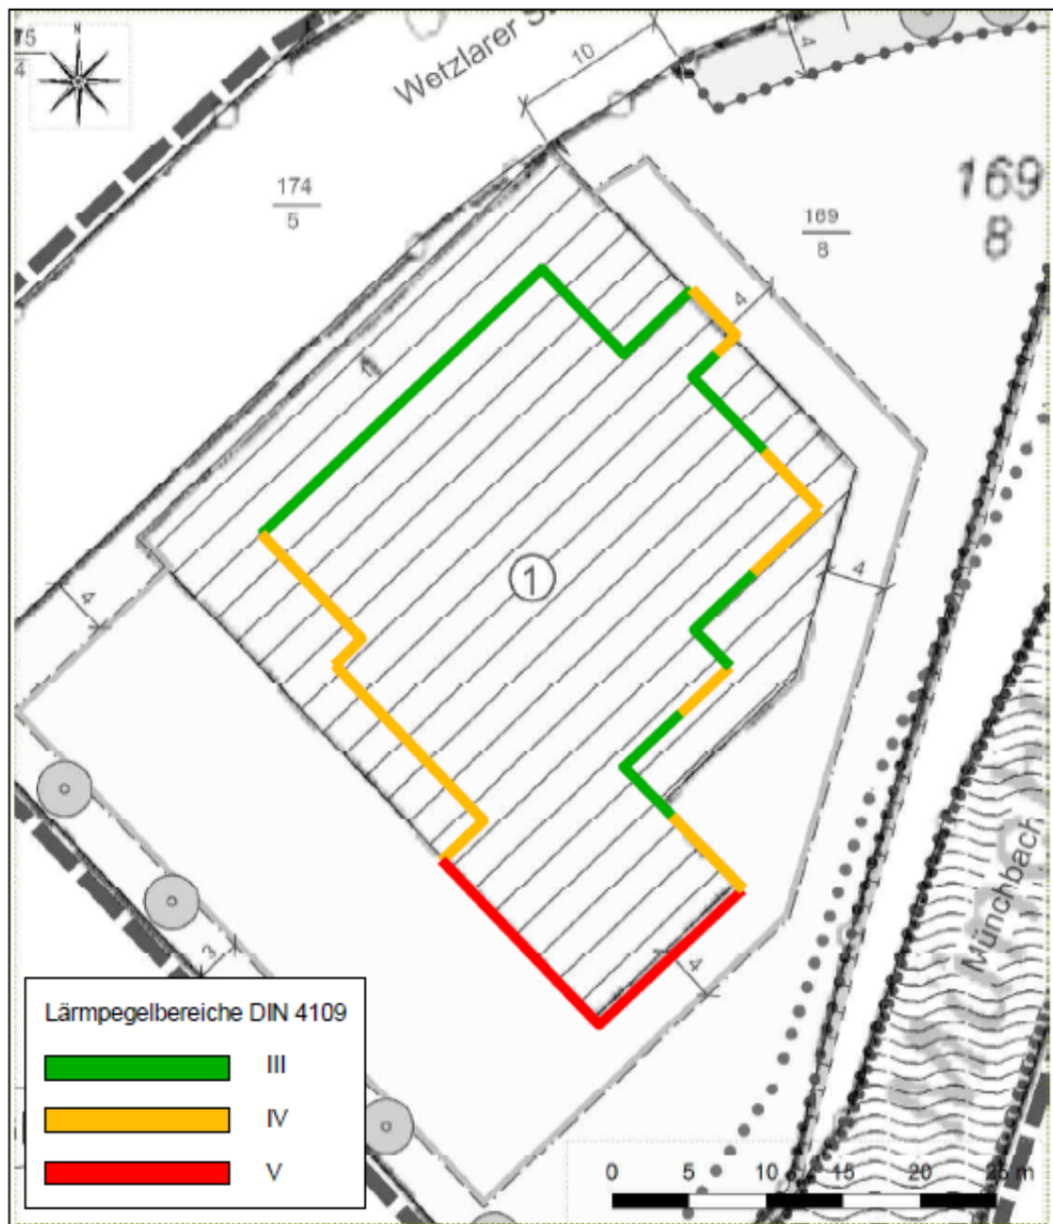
Lärmpegelbereiche Dachgeschoß.
